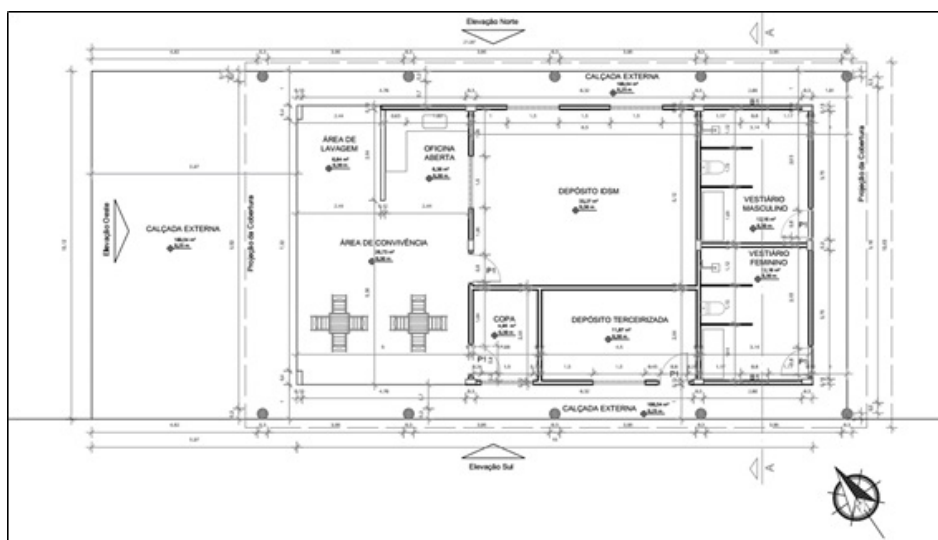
Planta baixa da Oficina e Depósito Coordenação de Infraestrutura e Logística.
